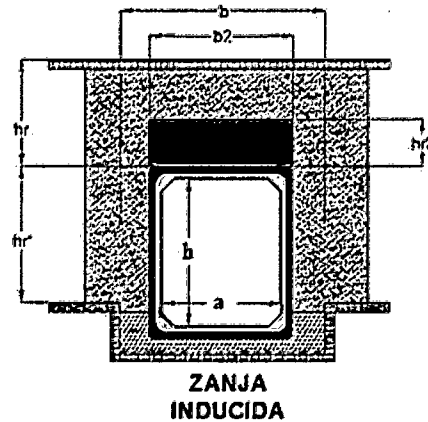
Marco de concreto armado con la instalación en zanja inducida en terraplén
